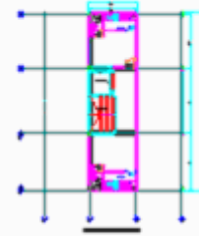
Planta modelo con muros. Modelo REC-360-0.15-0.25 M 8 m (15 PISOS)
